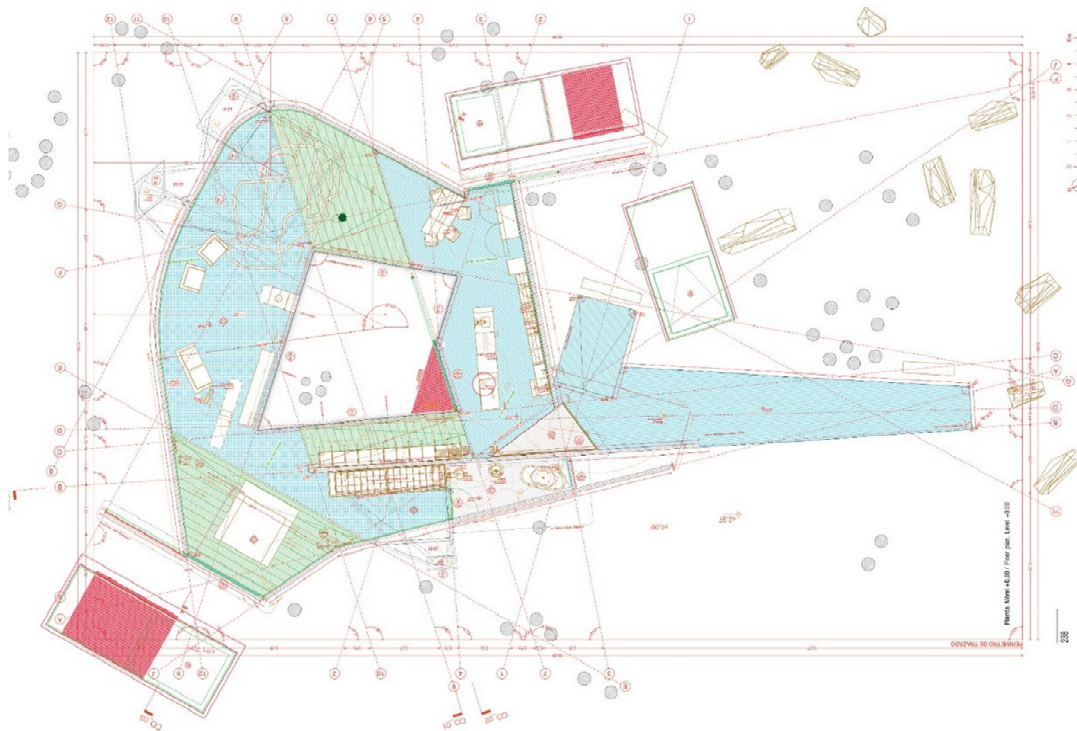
Casa para El Poema del Ángulo Recto: Planta Baixa.
